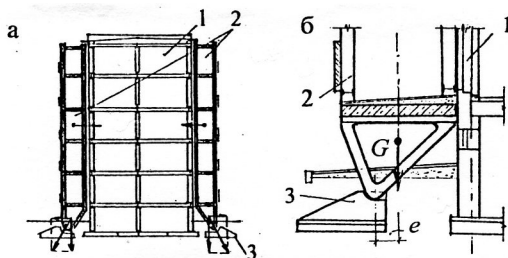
Реконструкция крупнопанельного пятиэтажного дома с предварительно стягиваемыми пилонами
